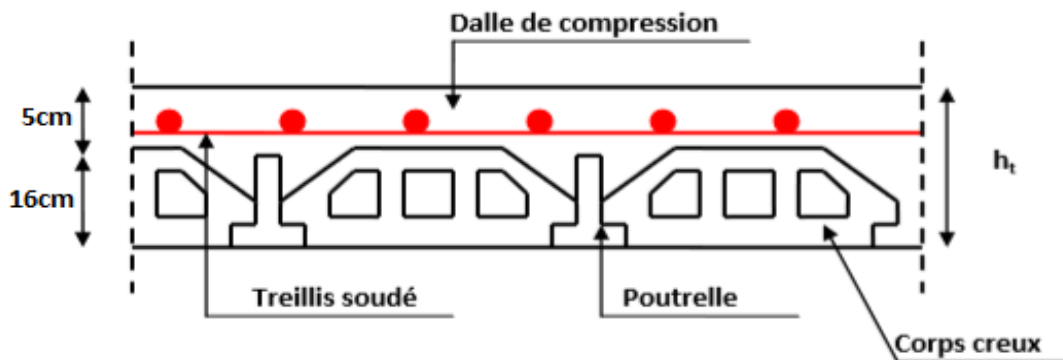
Coupe transversale d'un plancher à corps creux.
